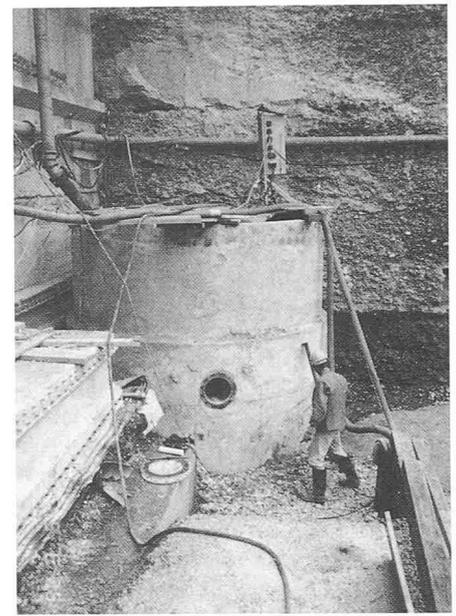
Senkschacht (Brunnenkammer) mit fächerförmigem Horizontalfilterbrunnen und Anschluss für Dükerrohr
